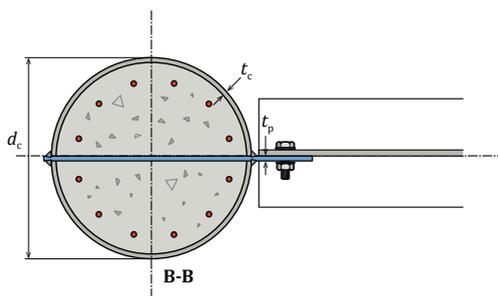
Assemblage articulé par plat traversant sur poteau mixte à section creuse circulaire
